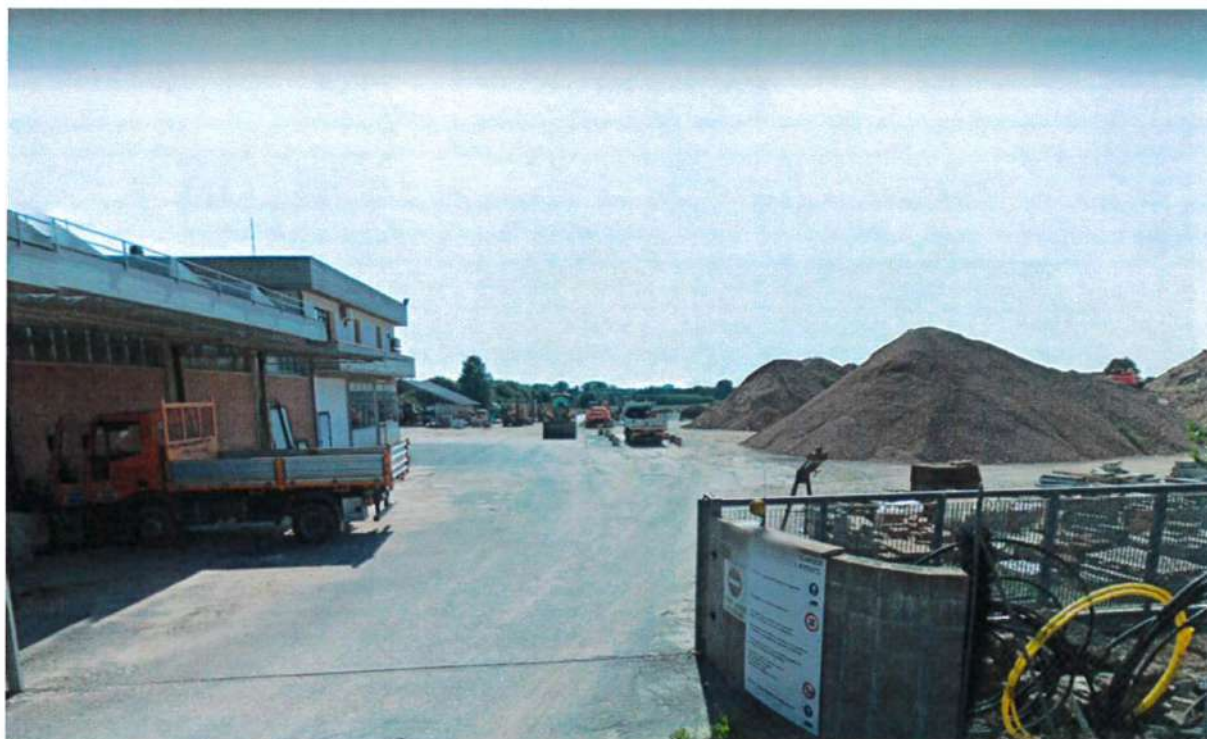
Immagine fotografica ripresa da NE lungo la traversa di Via della Botte, direttamente dall'ingresso dell'impianto.
